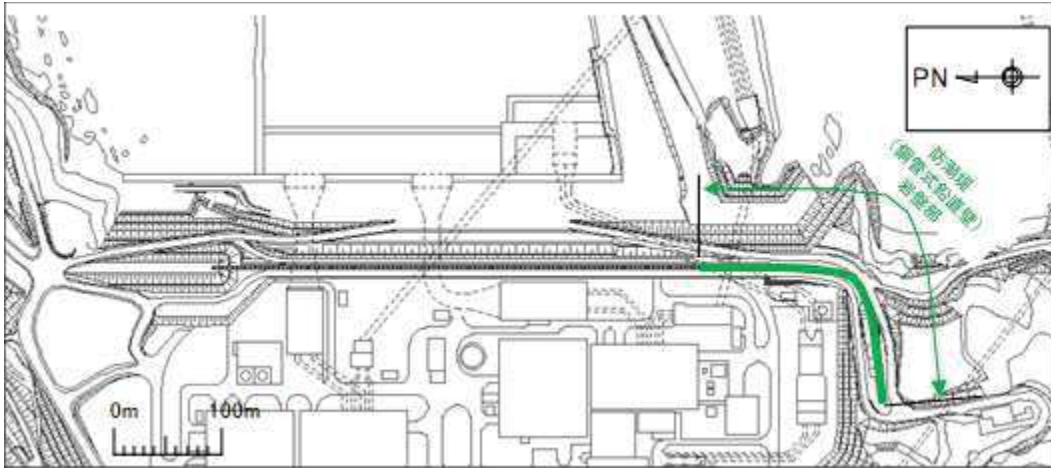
鋼管式鉛直壁（岩盤部）の平面配置図
